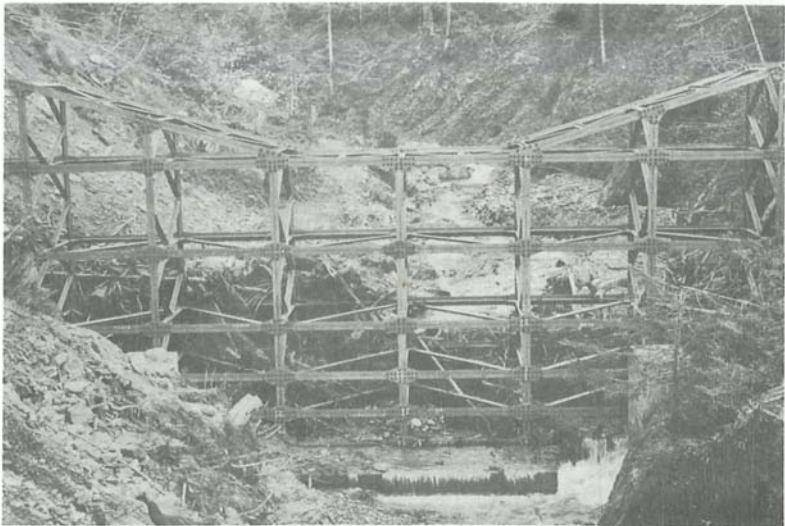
Fertiggestellte Gitterrostsperre nach einem Hochwasser mit aufgefangenem Wildholz und dadurch erfolgter Geschiebeanlandung
